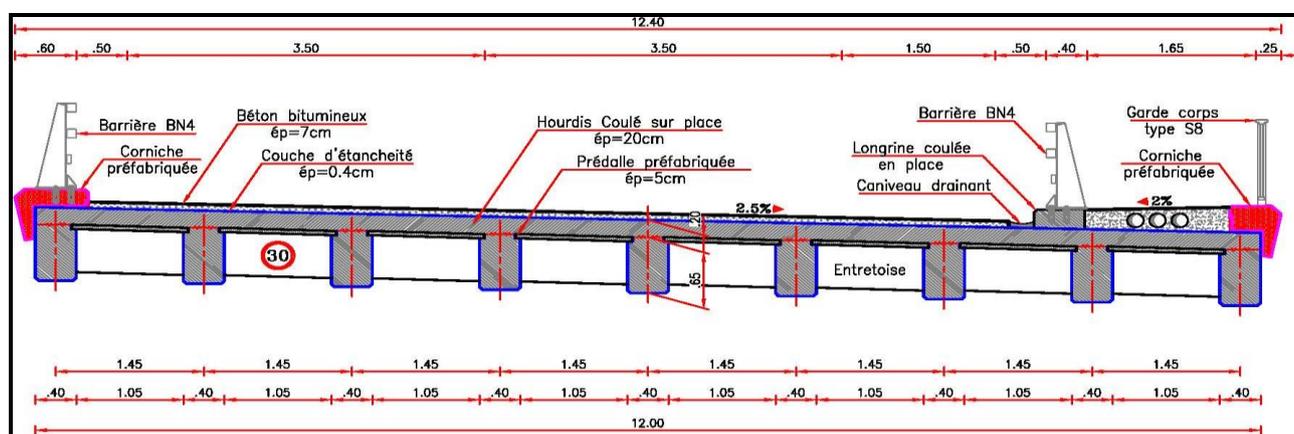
Coupe transversale du tablier des GOHs sur le lac Ahémé (pont à poutres en béton armé)
